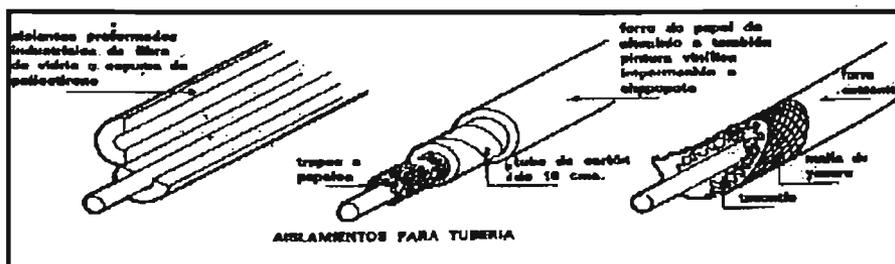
Aislamientos que se pueden utilizar para cubrir las tuberías
